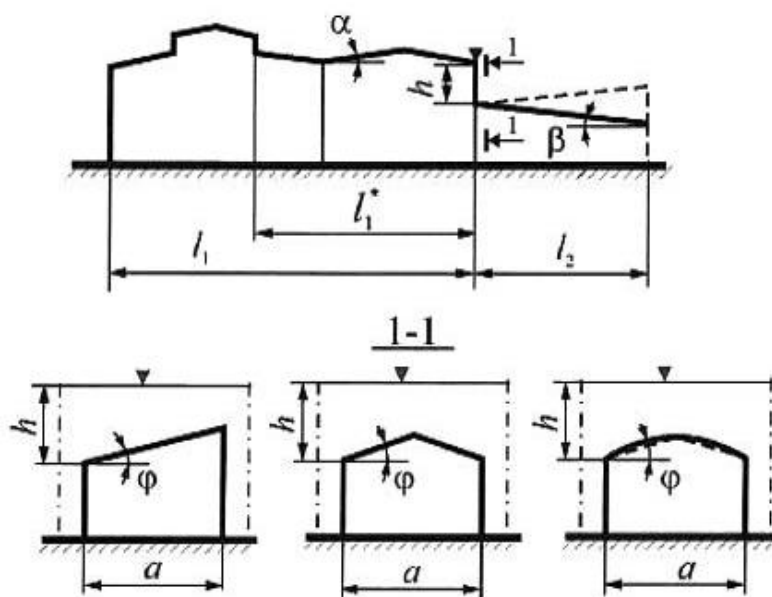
Схема расположения снеговой нагрузки на нижнее покрытие для зданий с перепадом высот
